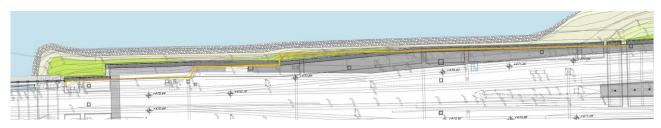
Planimetria Progetto definitivo su rilievo esistente
